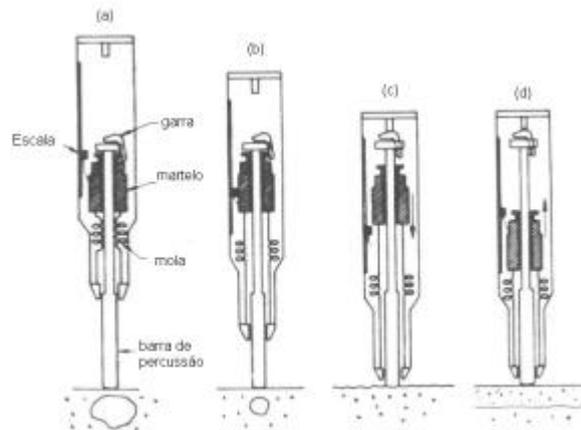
Esquema do ensaio de esclerometria (ACI 228,1988).
